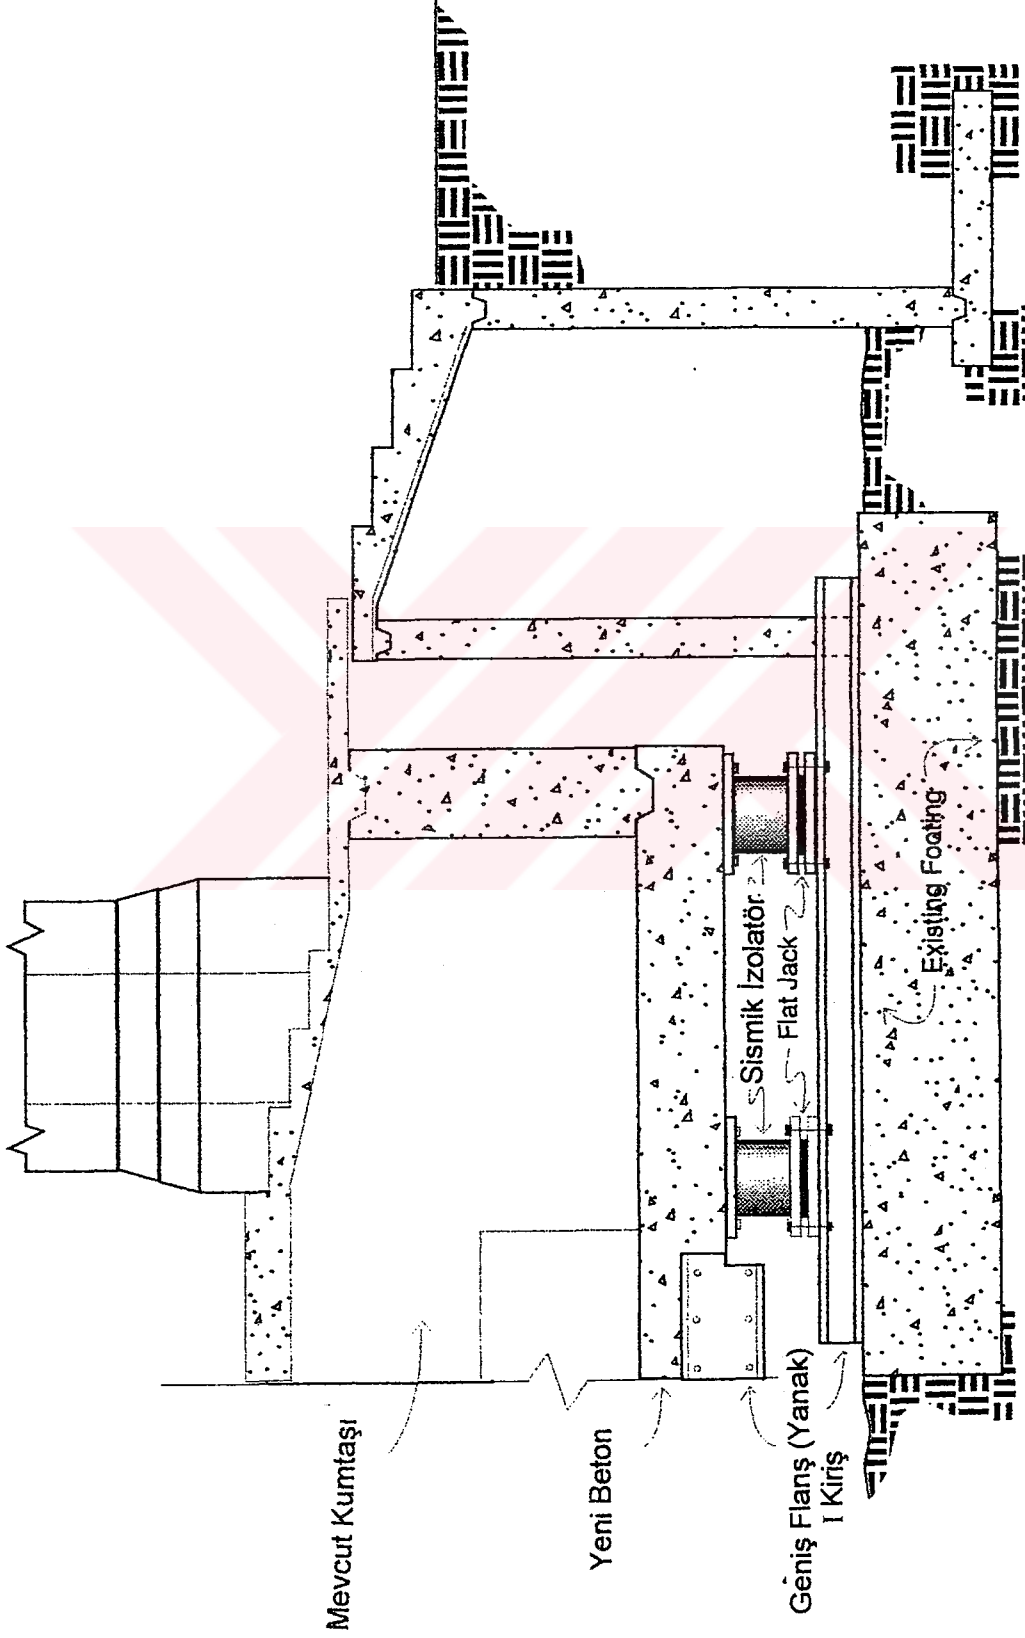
Sismik İzolatör Montajı – Betonarme Kolona
